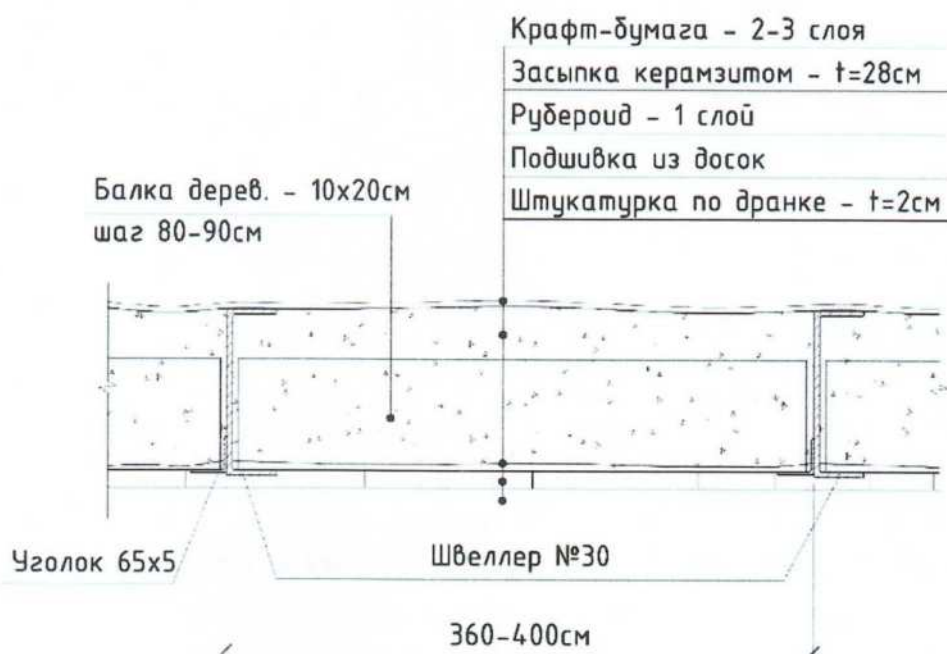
Конструктивное решение перекрытия 2-го этажа в месте вскрытия №4
